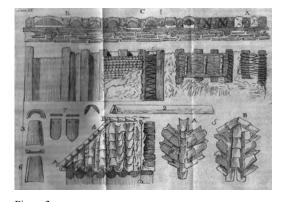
Lamina IX Sistemas de cubiertas y colocación de tejas (Villanueva 1827, 63)
